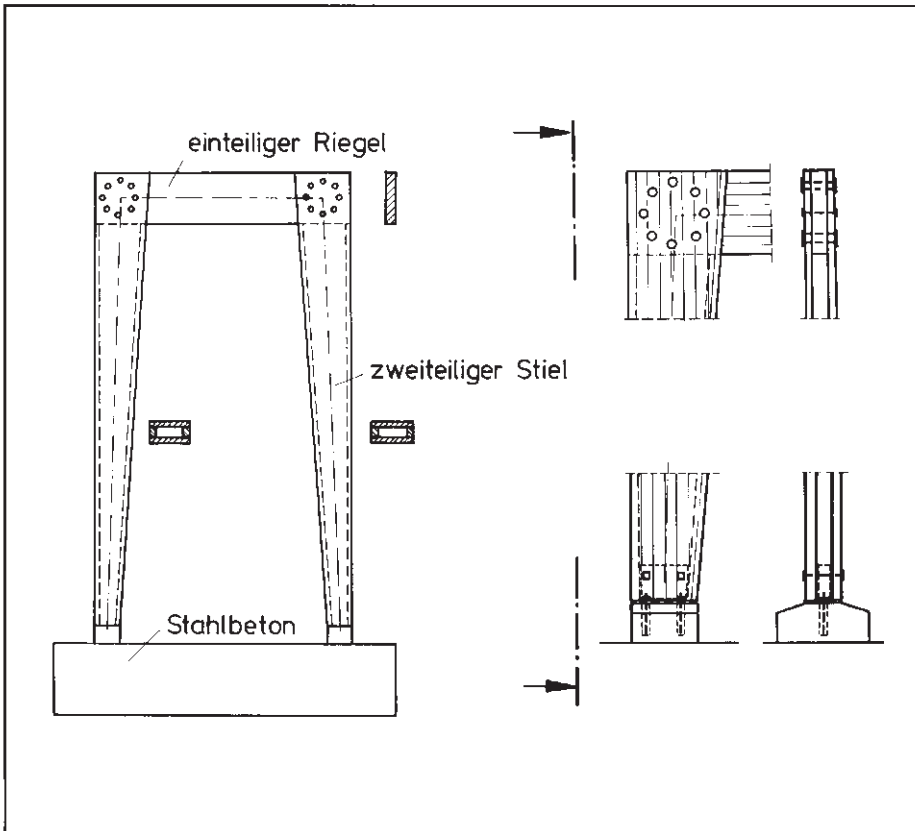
Zwischenaufleger mit einteiligem Riegel und zweiteiligem Stiel, Dübelverbindung
